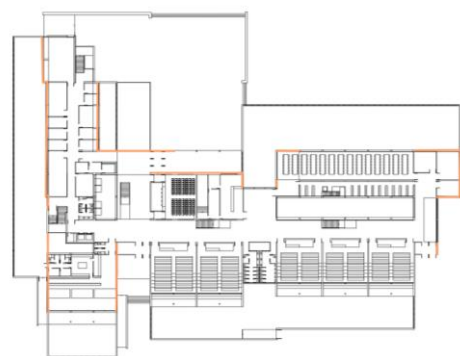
Esquema ubicación fachada G.R.C sobre pared de termoarcilla. Fuente: Elaboración propia
